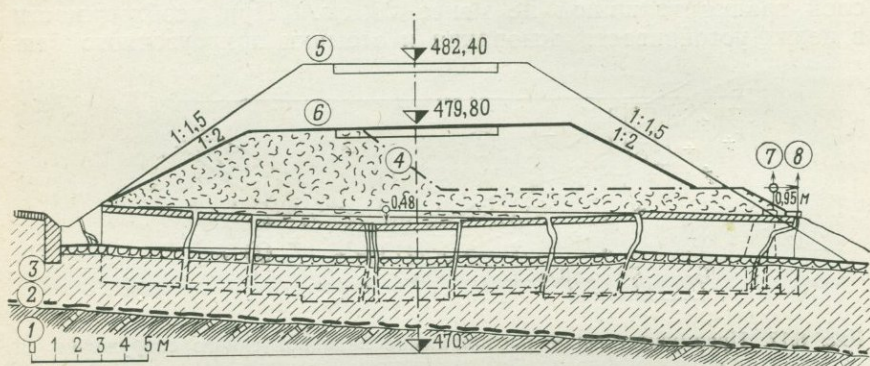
Разрушение водопропускного сооружения, уложенного на сжимаемый грунт, под влиянием веса насыпи.
